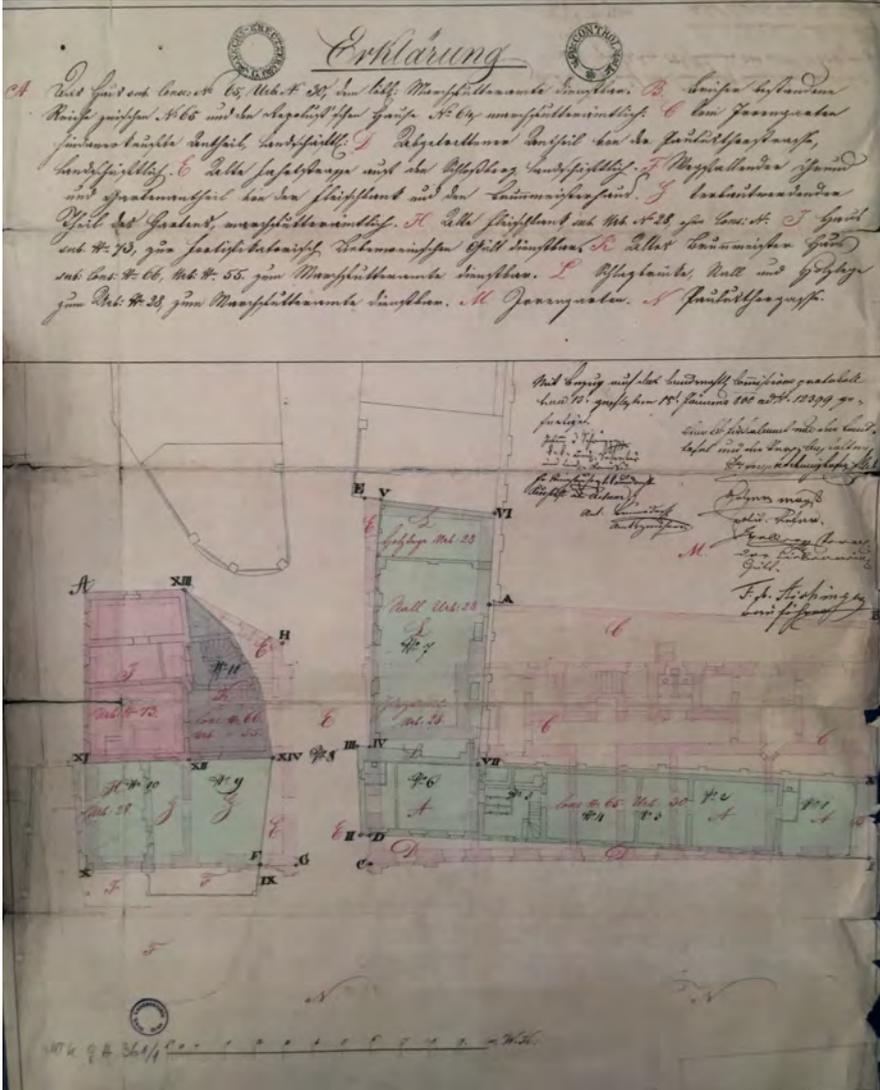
Grundrissplan des Vorgängerbaus (grün) und des Neubaus (rot) in der Paulustorgasse 1 und 3.
